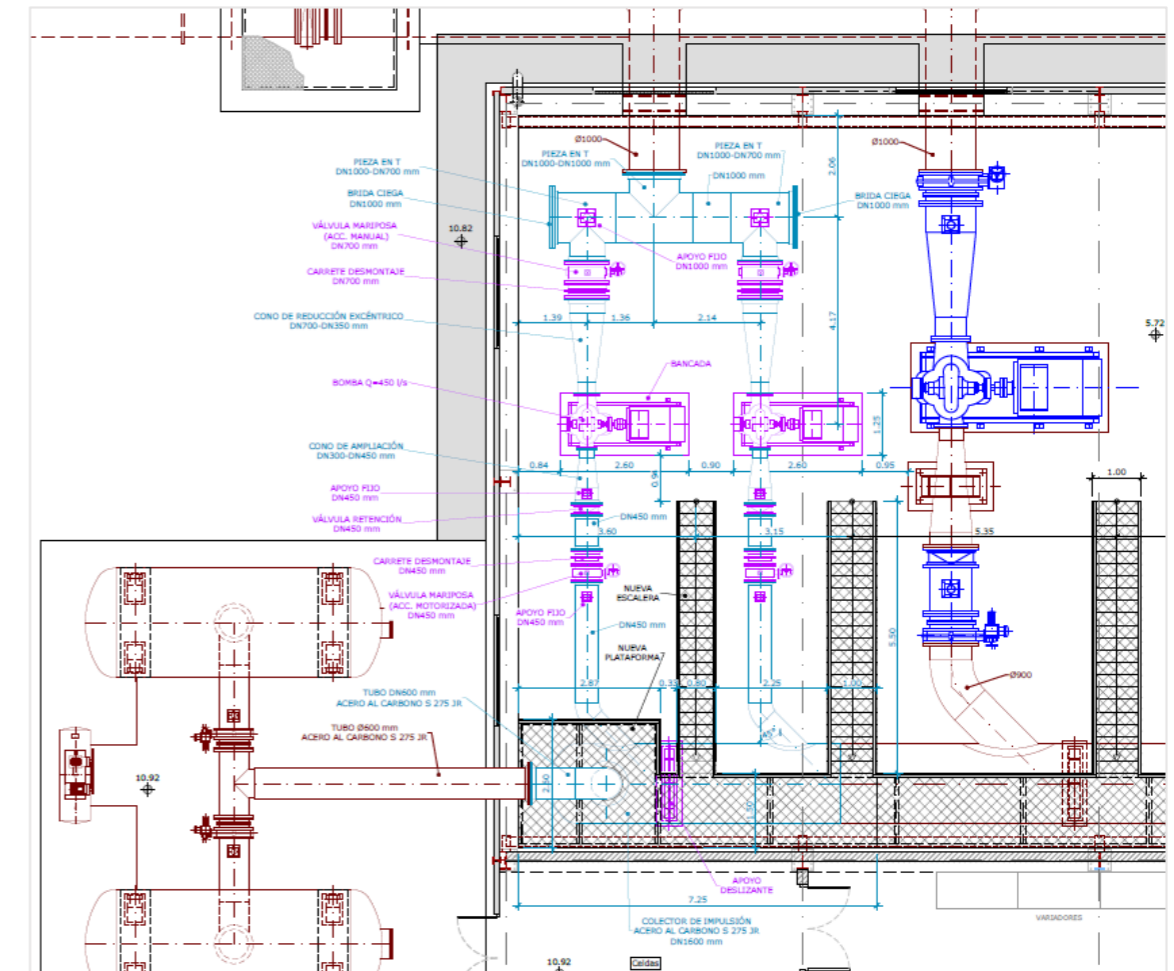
Planta situación proyectada. Estación de bombeo del sector Alcantarillas
